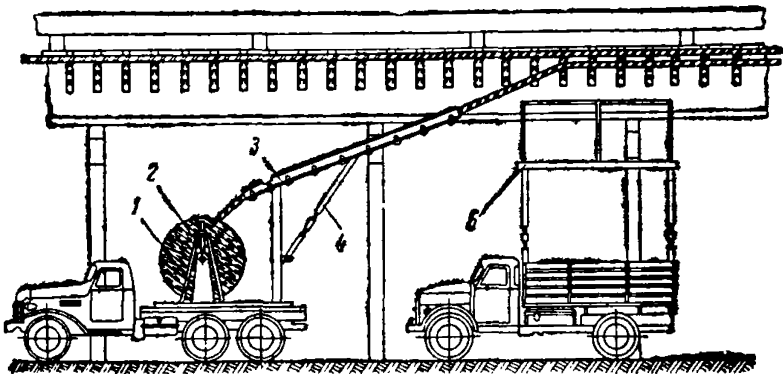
Прокладка кабеля по открытой эстакаде с помощью специально оборудованной автомашины
